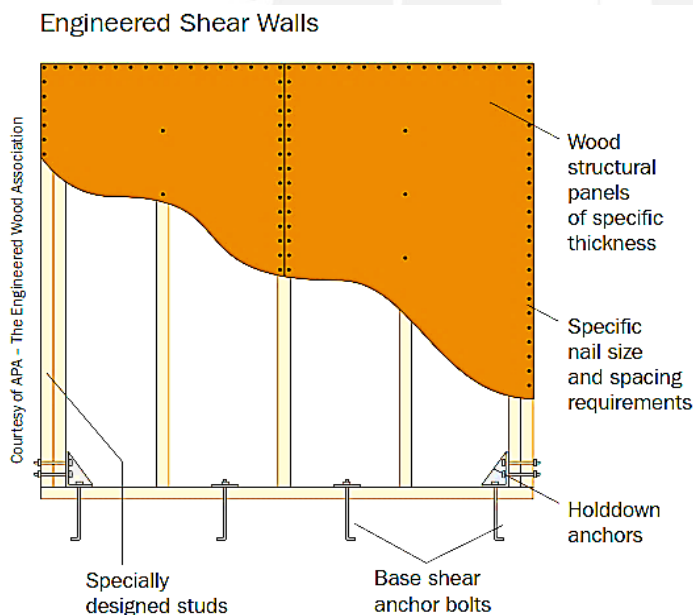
5 Muro de corte de estructura de Madera. APA-The engineered Wood Association.
